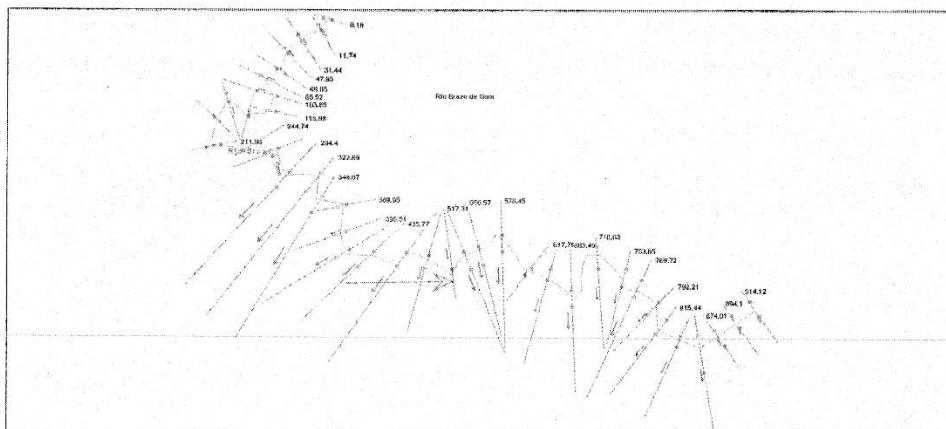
, Planta Río Brazo de Gómez en el Área del Proyecto.
